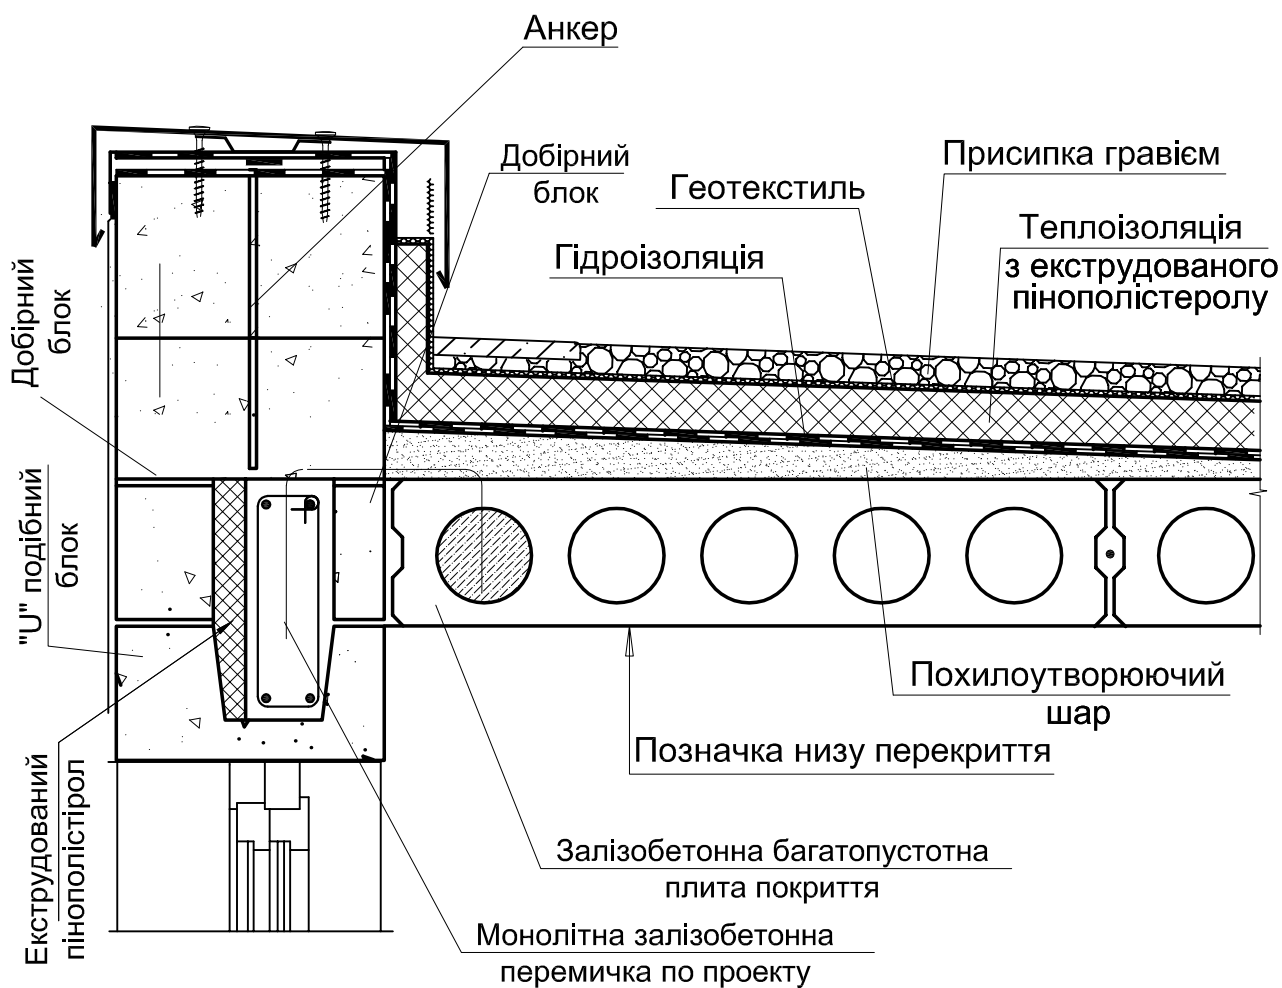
Конструювання утепленого плоского даху над збірно-монолітним дрібноштучним перекриттям даху. Проекція поперек несучих плит
